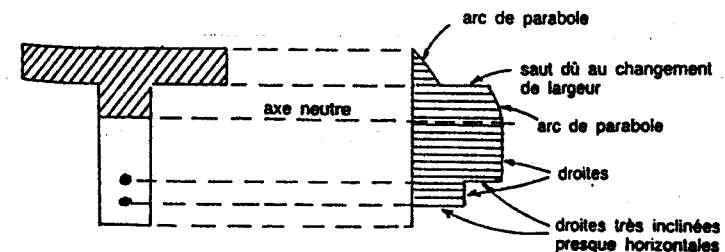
Contrainte de cisaillement d'une poutre en T
